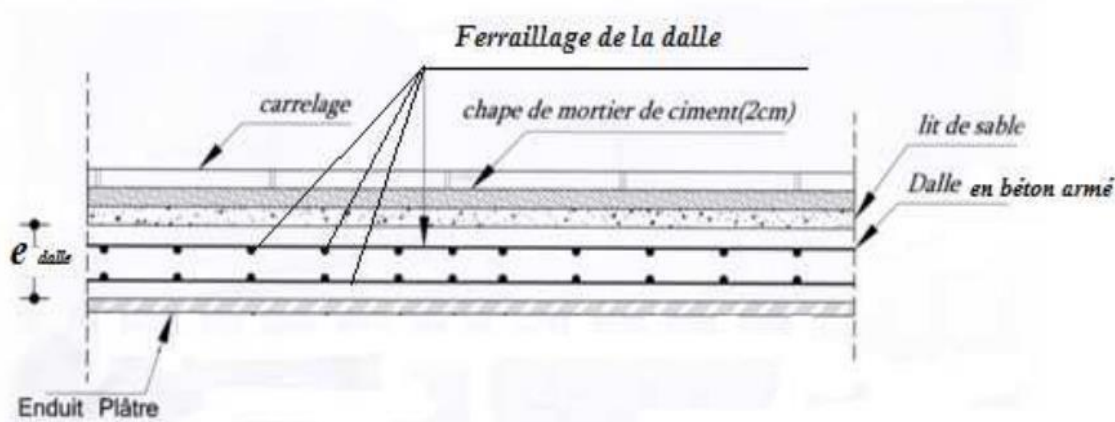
Détails d'un plancher en dalle pleine en béton armé (Plancher étage).
